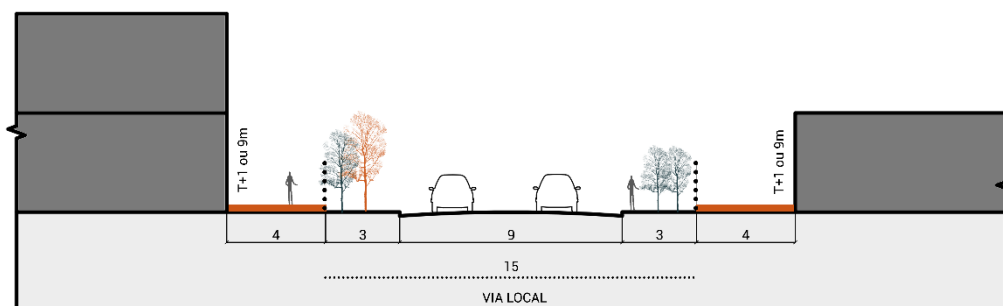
Corte esquematizado via Local Elaboração: Polo Planejamento, 2020.
